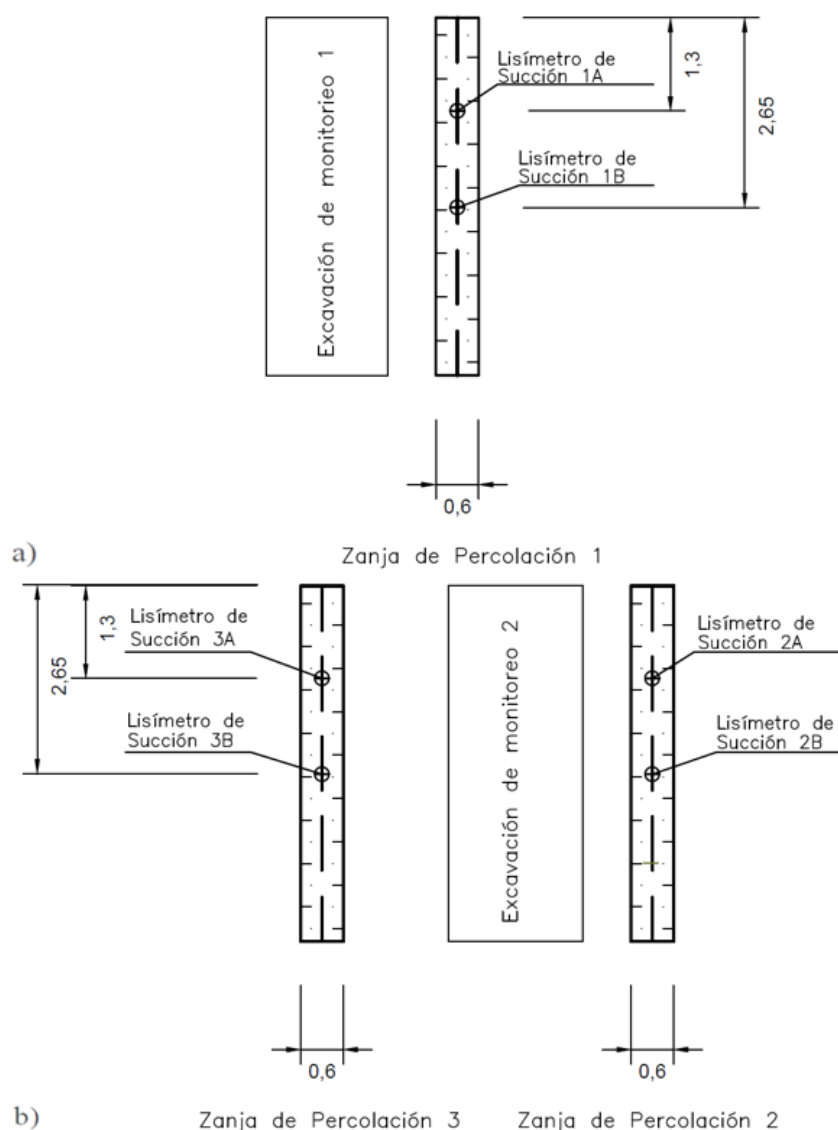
a) vista en planta de la ubicación de los lisímetros de succión de la zanja de percolación 1; b) vista en planta de la ubicación de los lisímetros de succión de la zanja de percolación 2 y 3.
